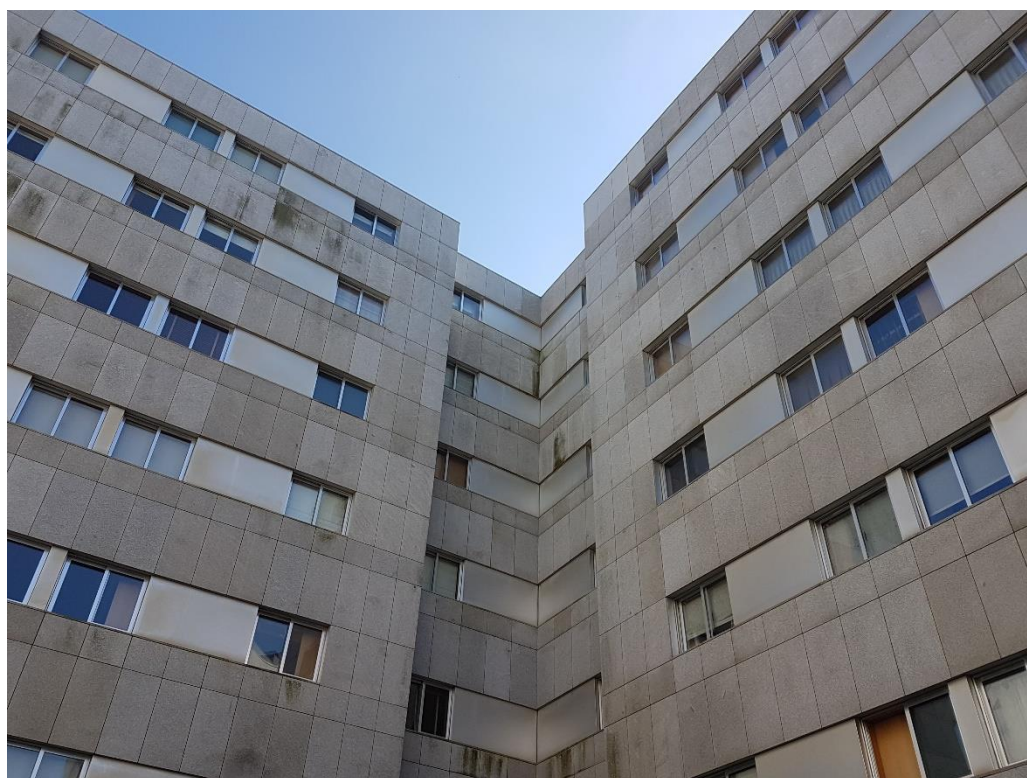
Canto interior da fachada Nordeste do edifício 11.
